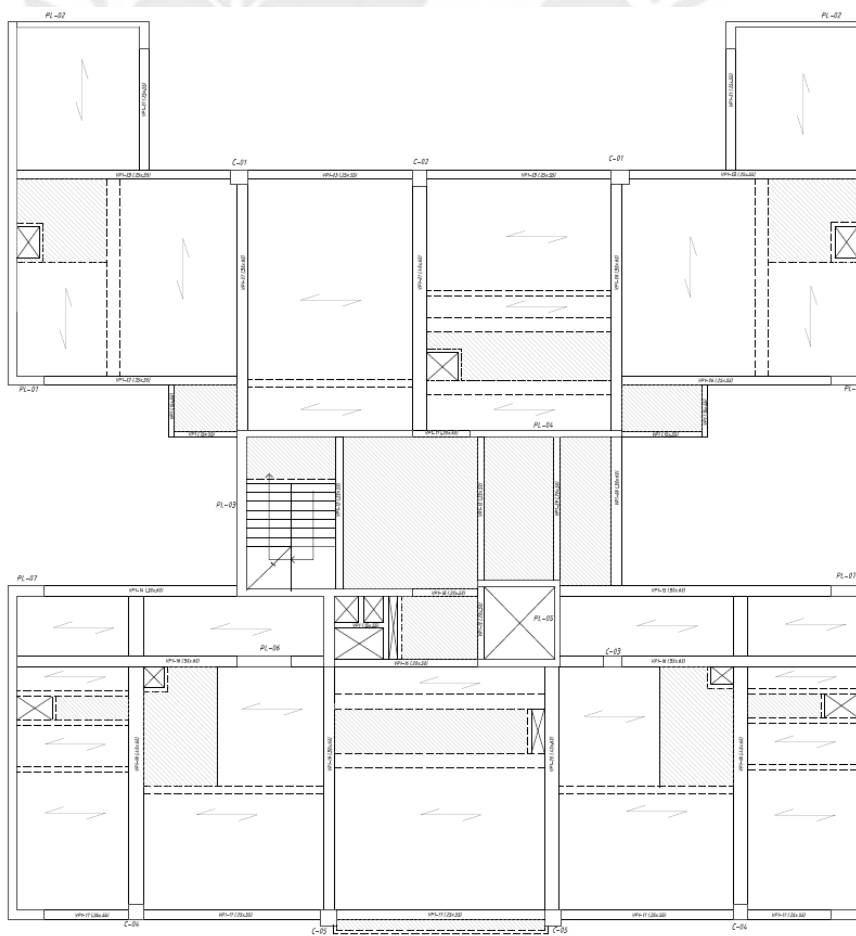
PREDIMENSIONAMIENTO FINAL DE LA ESTRUCTURA.
